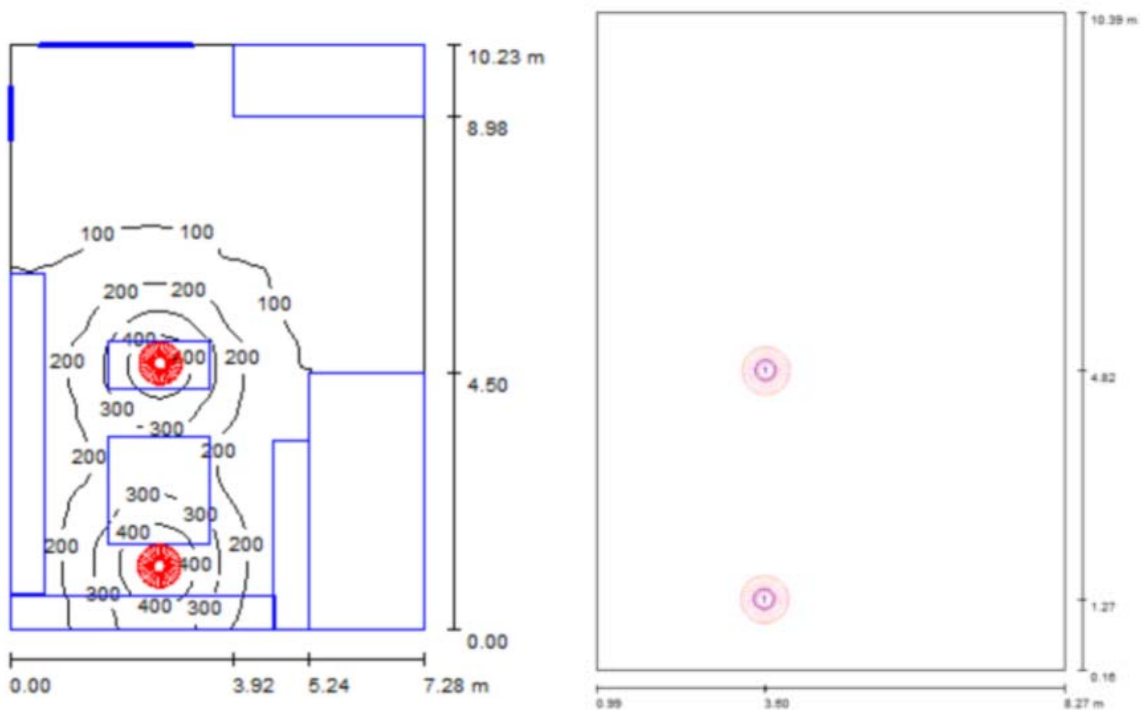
Schema planimetrico con lampade (valori in lux) Figura 670 - Lampade (planimetria)
